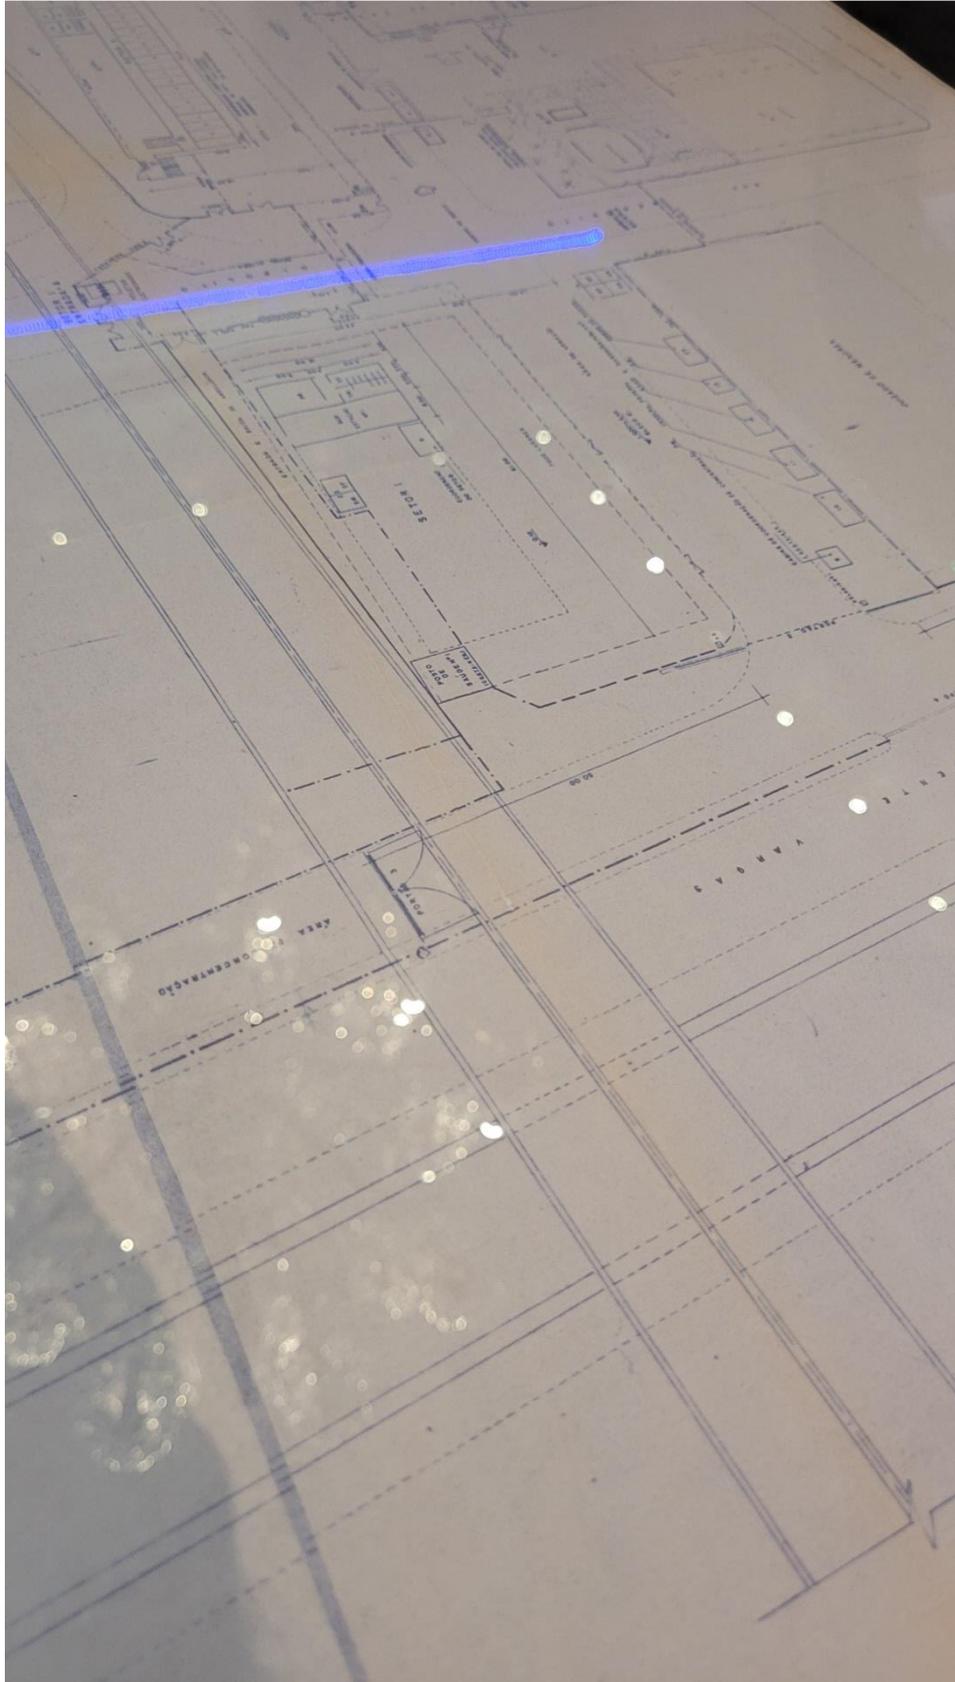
Detalhe da planta original do Sambódromo do Rio de Janeiro.
